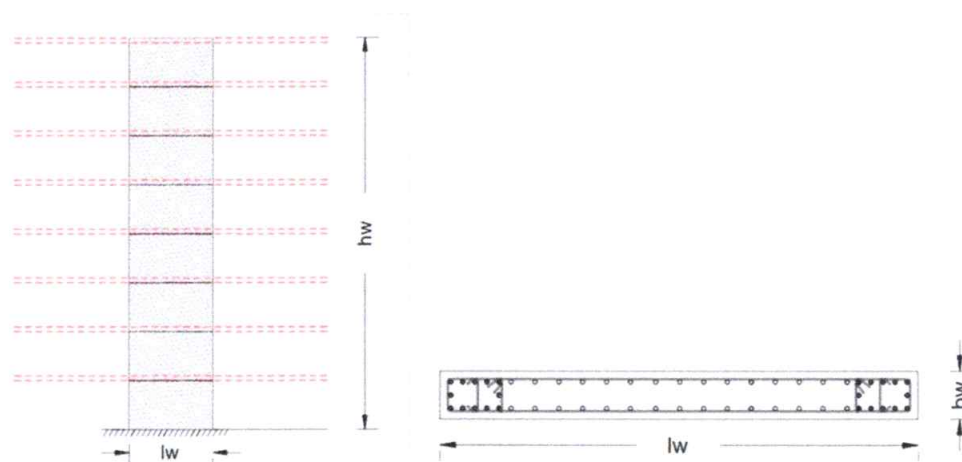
Geometría general del muro estructural. Fuente: Alcívar Stalin, 2020
